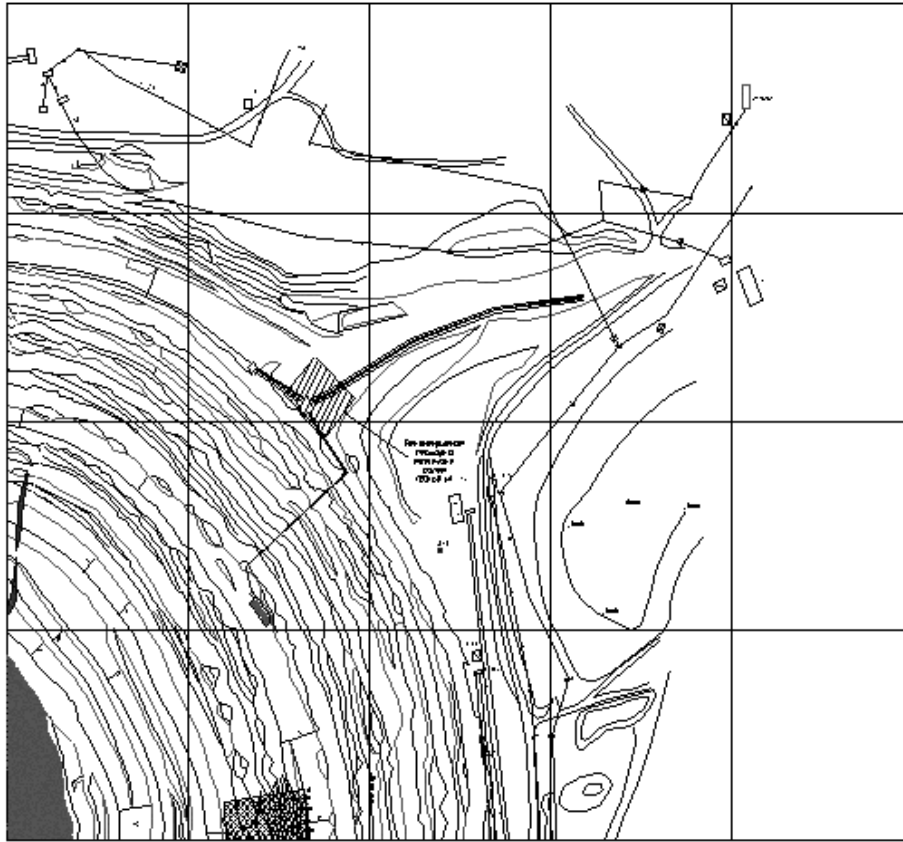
Схема размещения площадки для разгрузки солей на карьере «Мир»
